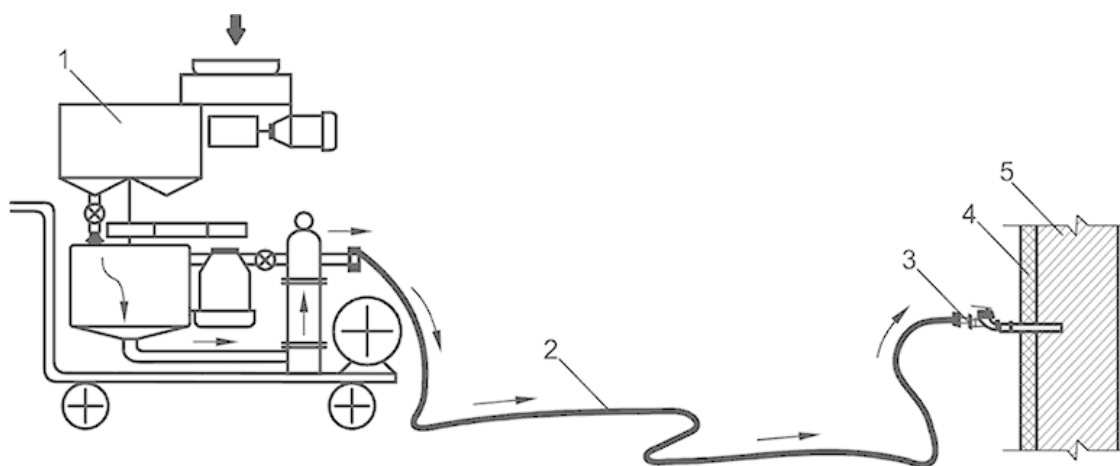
Схема инъектирования отверстий при анкеровке плит к наружным стенам (стрелками указано направление движения раствора): 1 – инъекционный агрегат; 2 – шланг; 3 – инъектор; 4 – пенополистиролбетонные плиты; 5 – наружная стена
